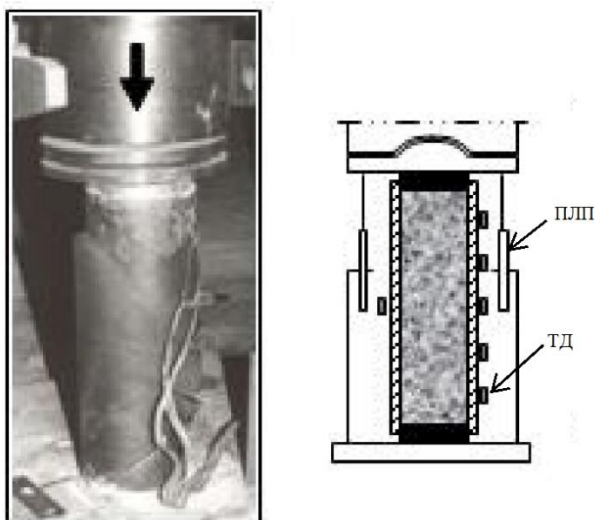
Трубобетонные образцы Amir Fam и др.: общий вид нагружения и схема установки измерительных устройств
